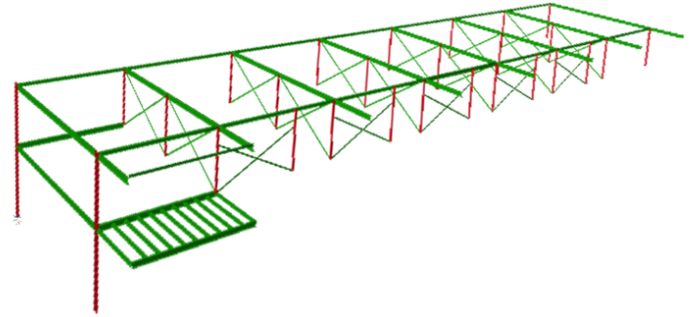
IMAGEN DEL MODELADO DE LA ESTRUCTURA DE LAS AULAS
